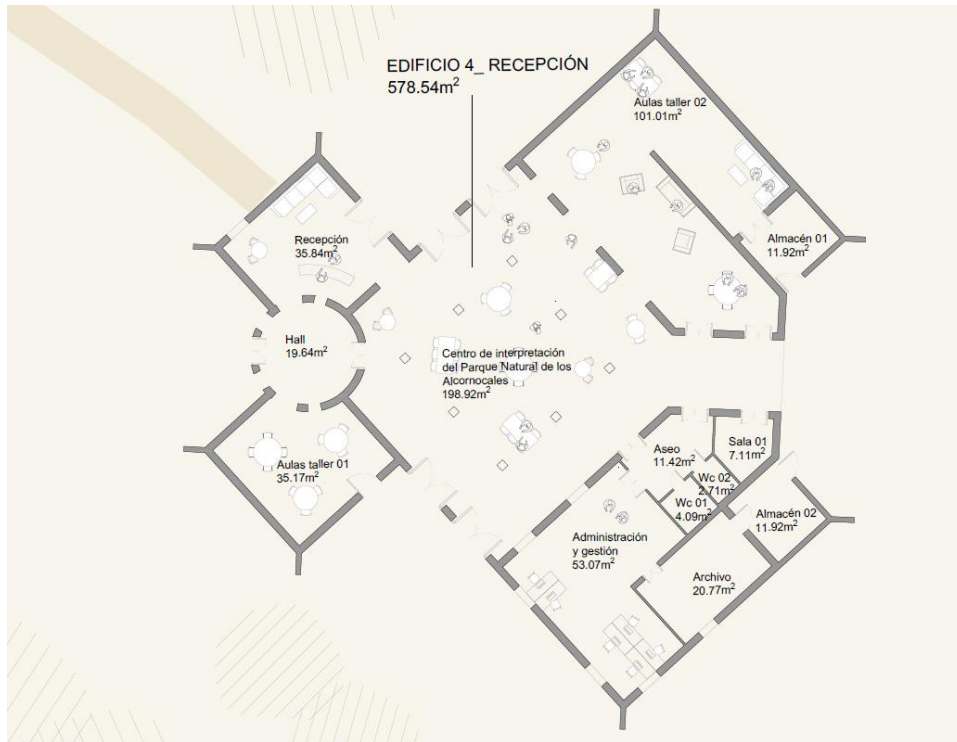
Planta de edificio de recepción, centro de interpretación y tienda local.
